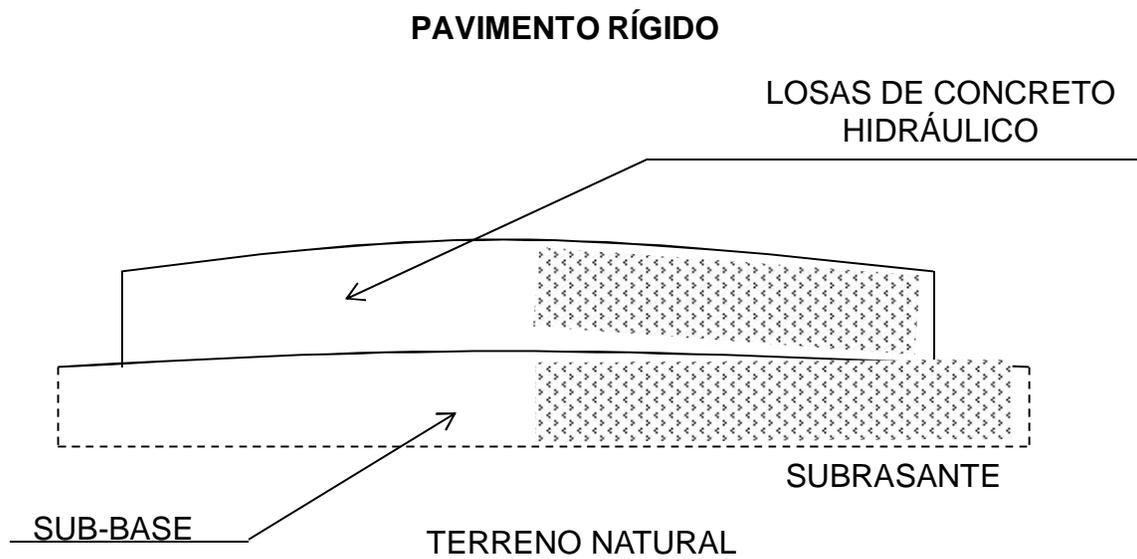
Capas constitutivas de un Pavimento Rígido.
